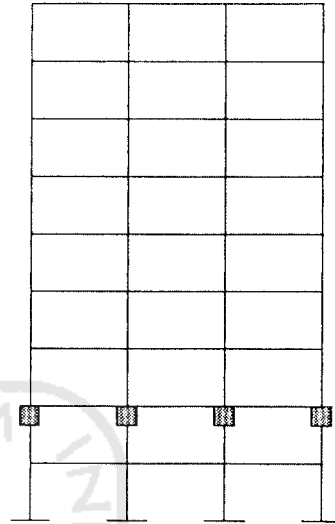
Tingkat 7 lantai ke 6
